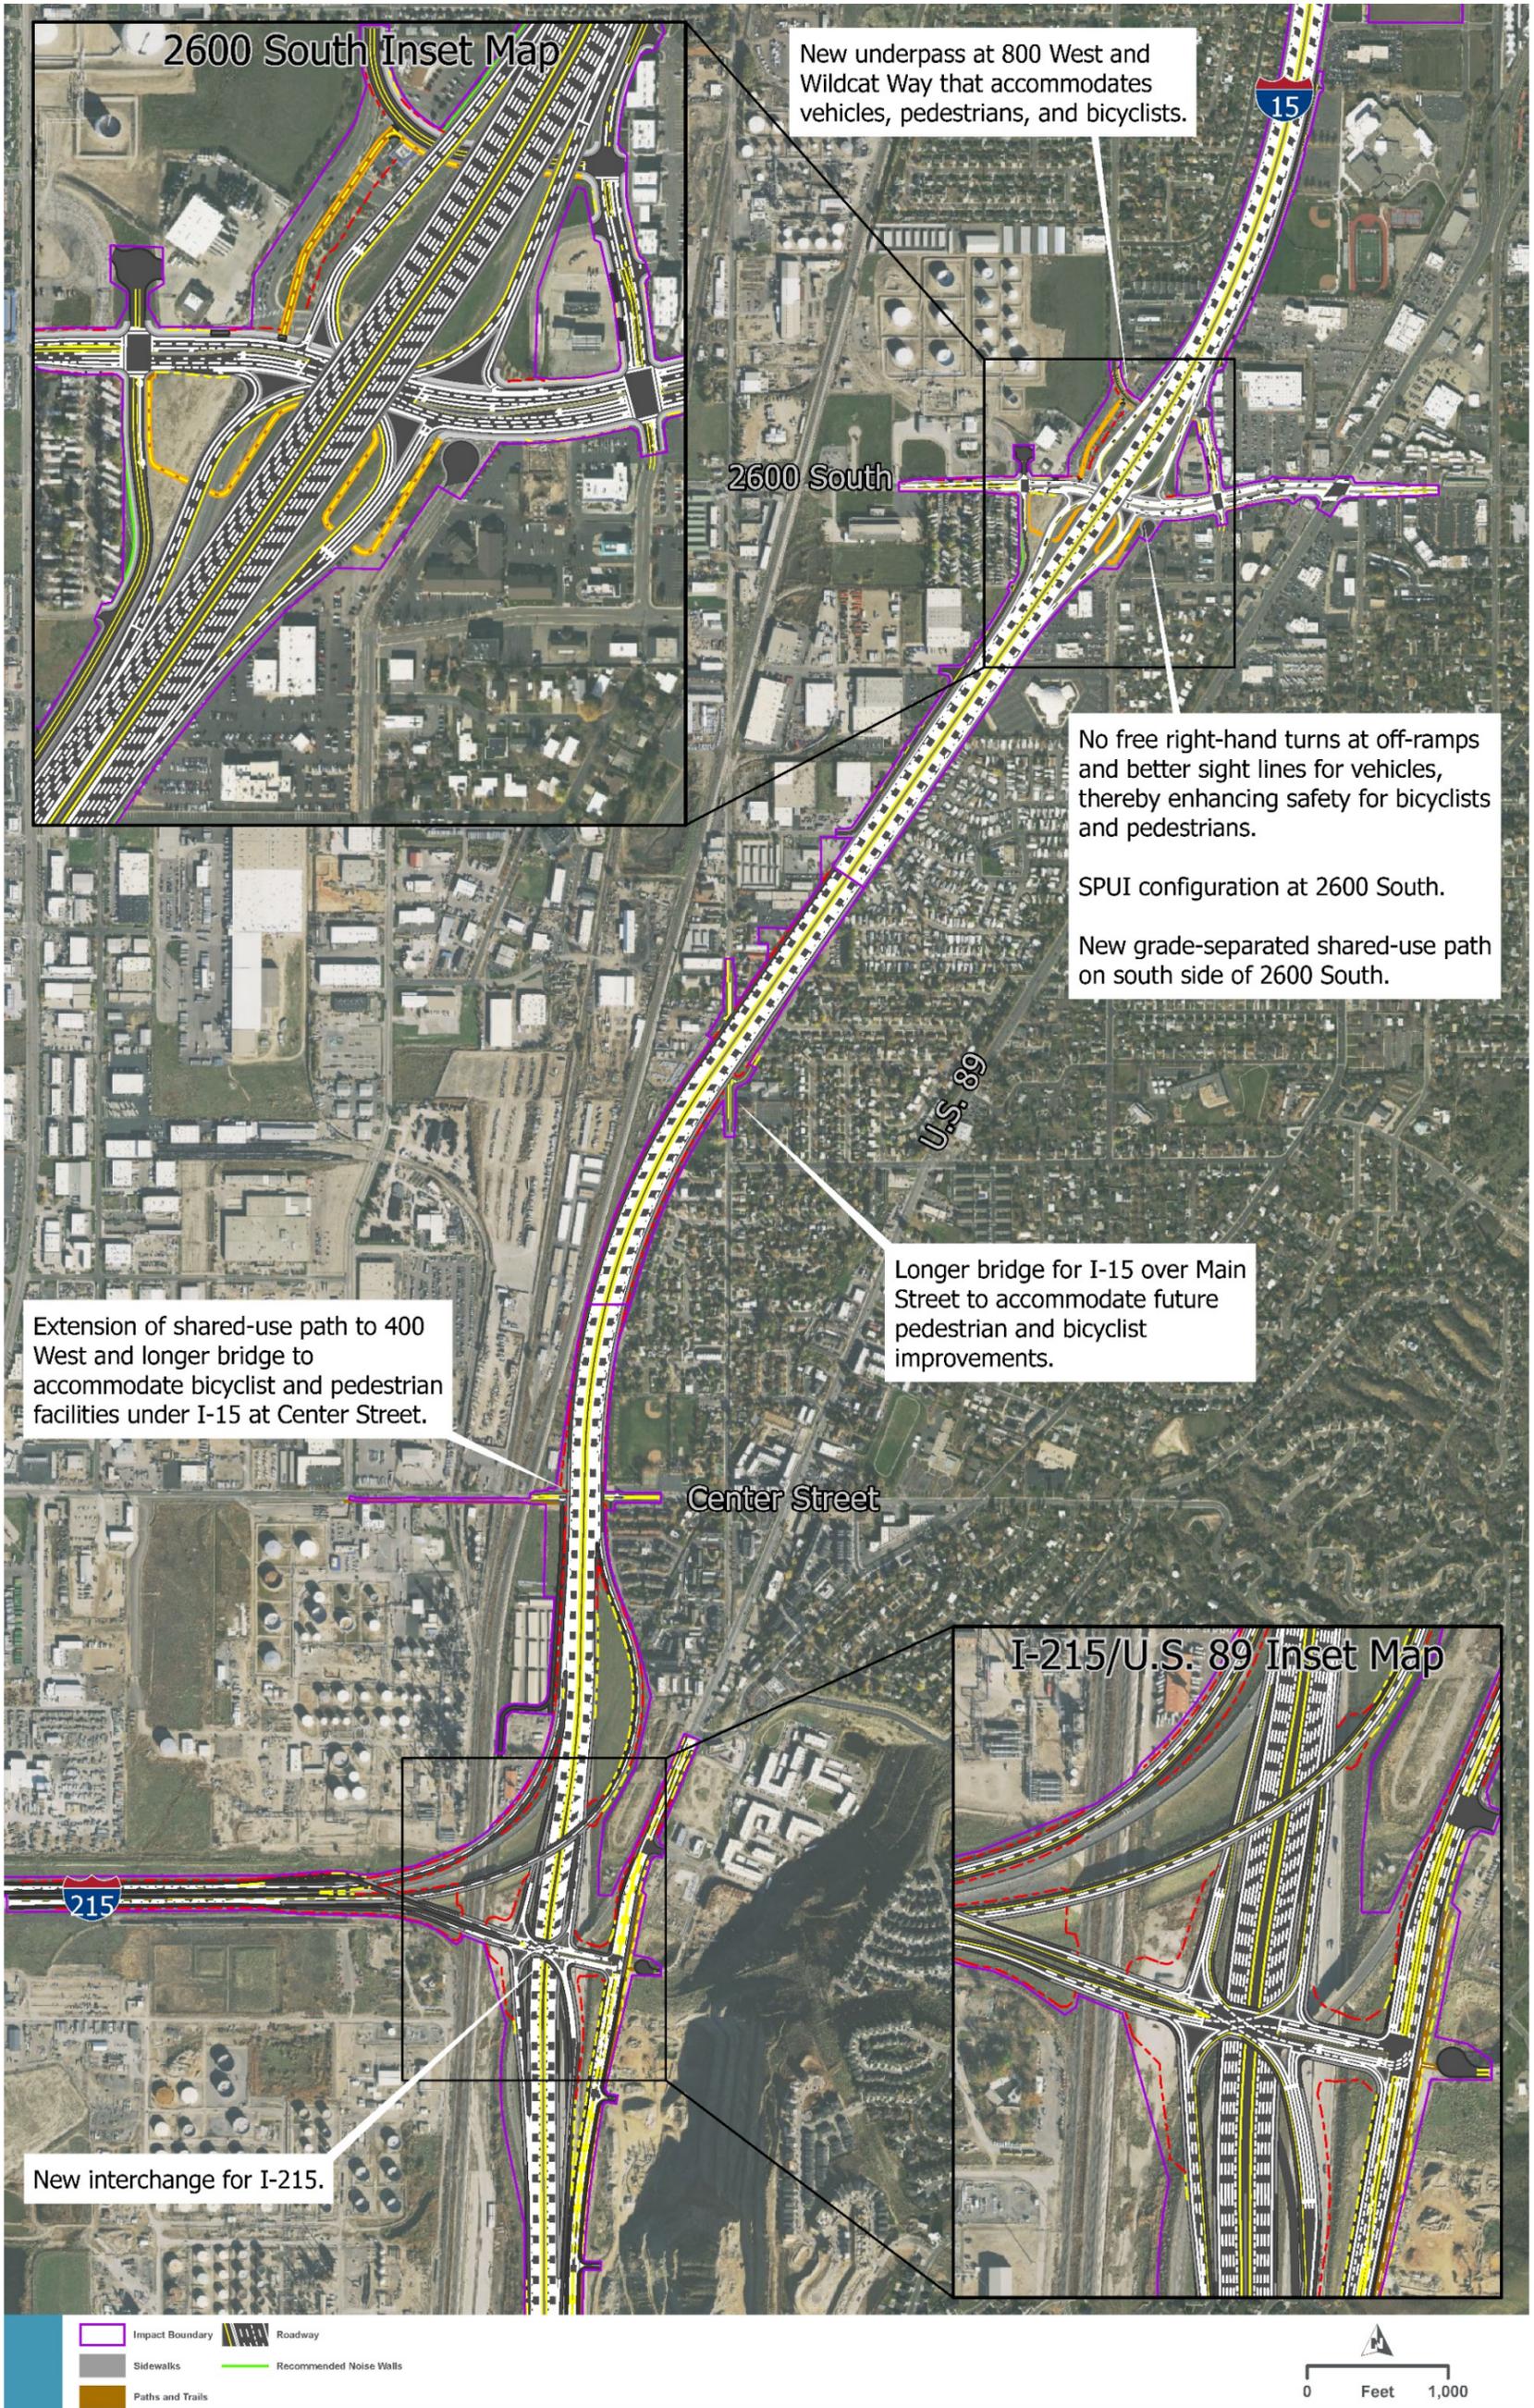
Alternativa de Acción: Center Street North Salt Lake
